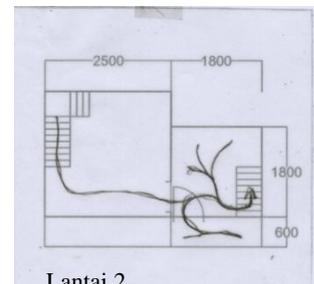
Gambar denah lantai 2 rumah mbak Ai
